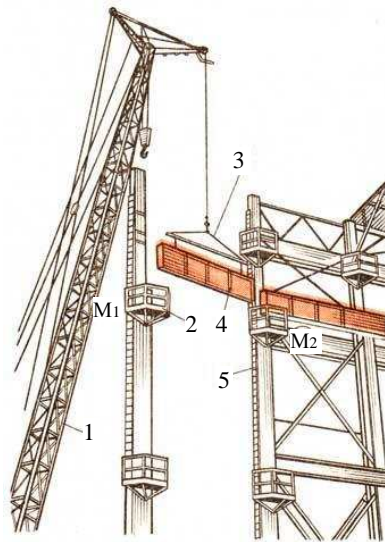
Схема монтажу підкранових балок: 1 – монтажний кран; 2 – риштування (колиска); 3 – траверса; 4 – підкранова балка; 5 – драбина; М1, М2 – монтажники
